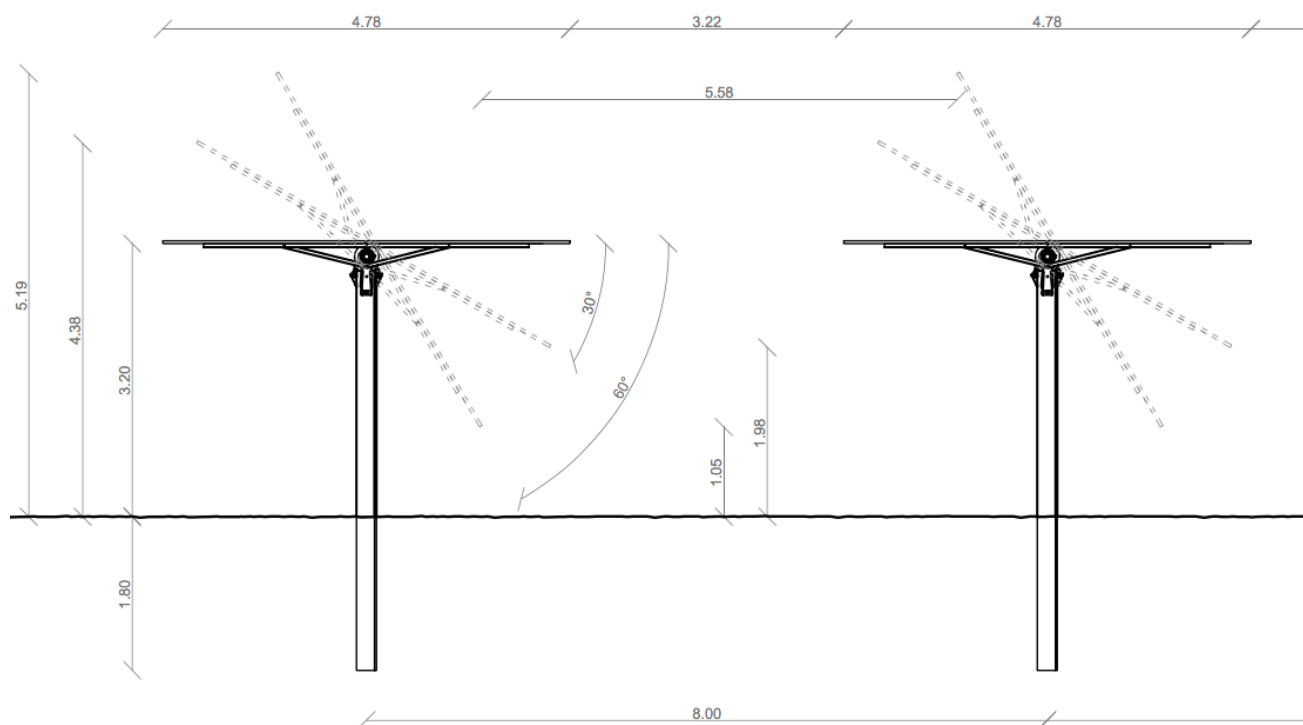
Prospetto trasversale Tracker Tipologia 2V (vista Est-Ovest).
